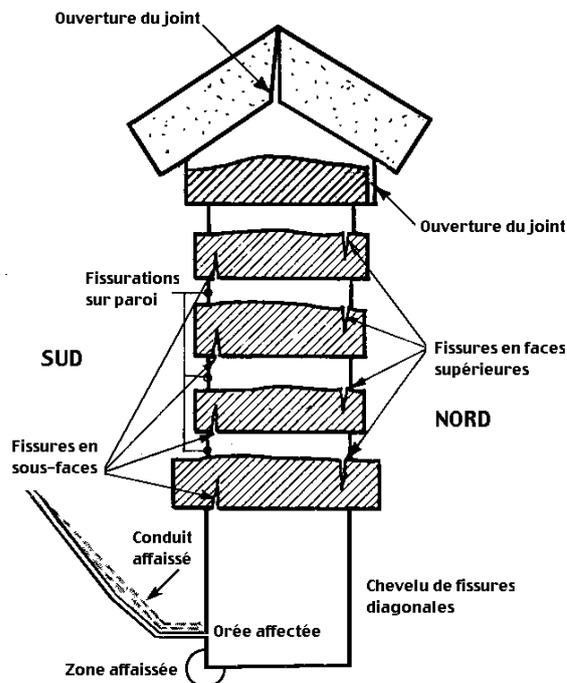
Configuration de la pathologie : localisations des différentes fissurations, affaissement du conduit sud et de son orée, déplacement du dernier étage de monolithes, ouverture du joint entre chevrons et affaissement des chevrons sud.
